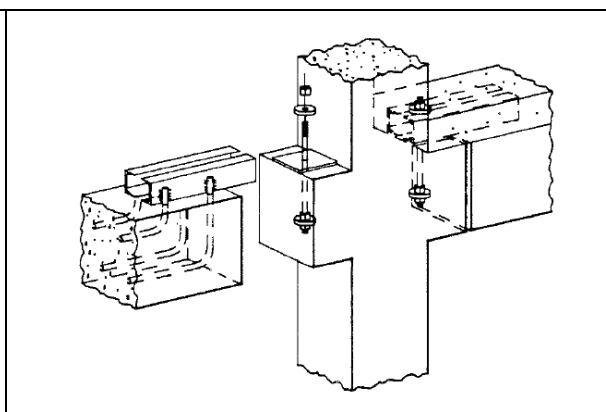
Ligação por consola curta com armaduras em gancho (Sidney, 2000)
